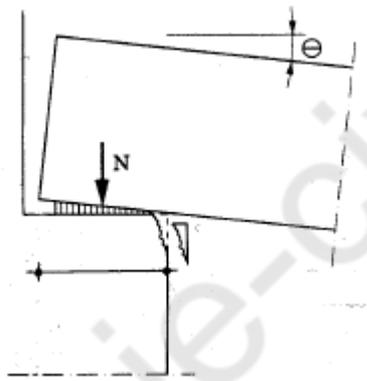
Longueur d'appui nominale des planchers préfabriqués
